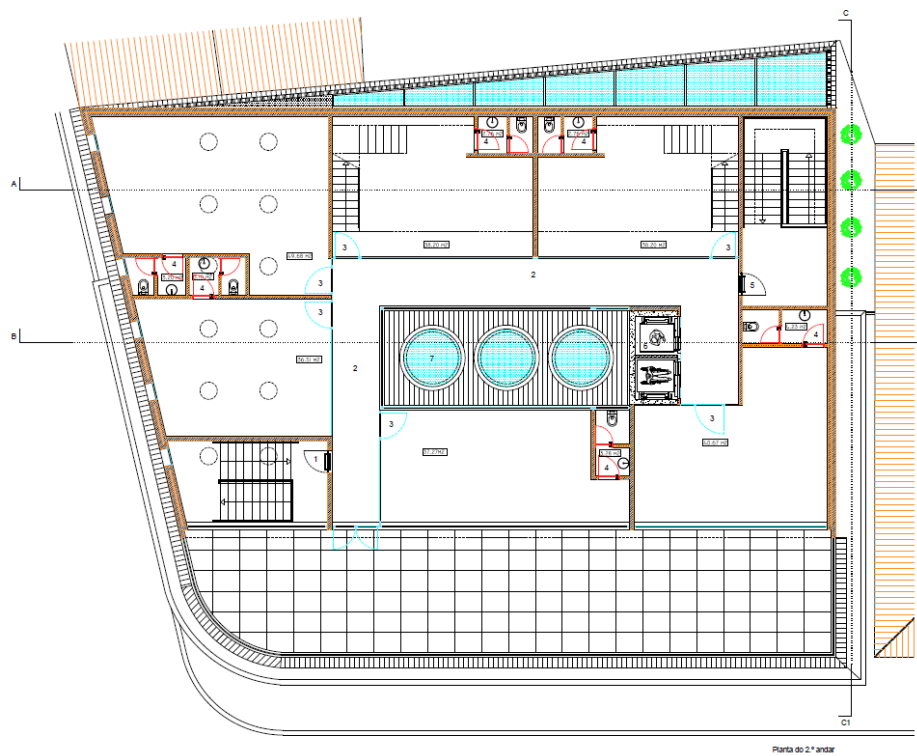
Planta do segundo andar. Fonte: Corcovado Construções.
